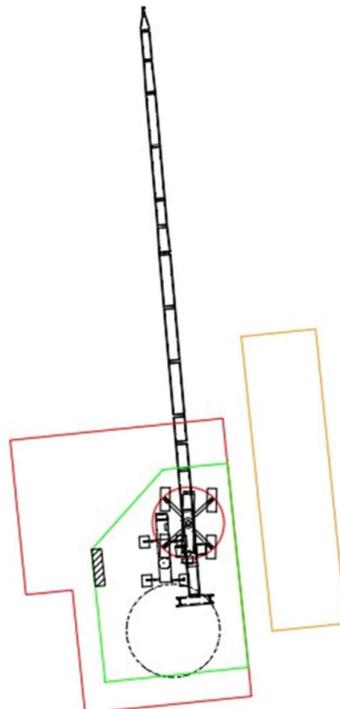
Vista dall'alto con Cabina di raccolta e gru da 200t
